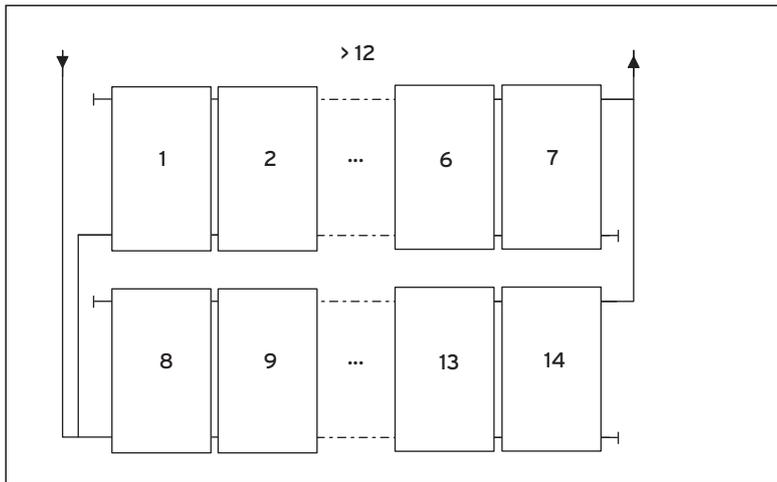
Conexión en paralelo (VFK 125/3 / 145/2 V)
